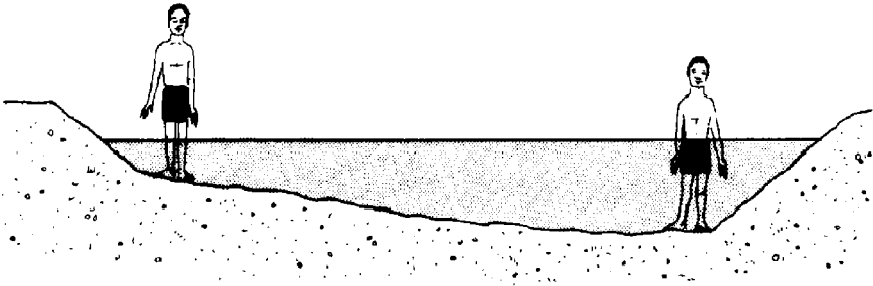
Coupe transversale d'un étang (Murnyak et Murnyak, 1990).
